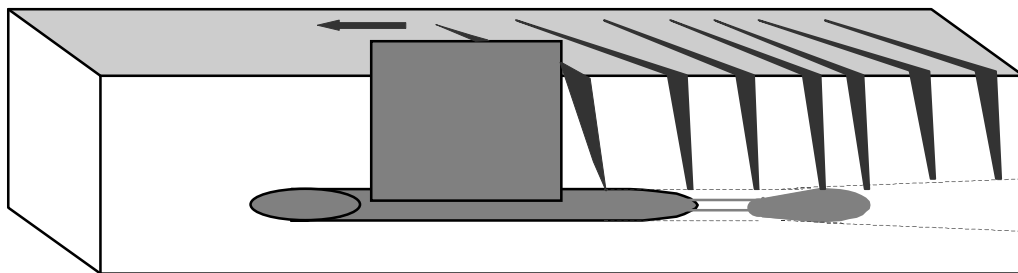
Implantação de drenos livres com subsolador do tipo torpedo
